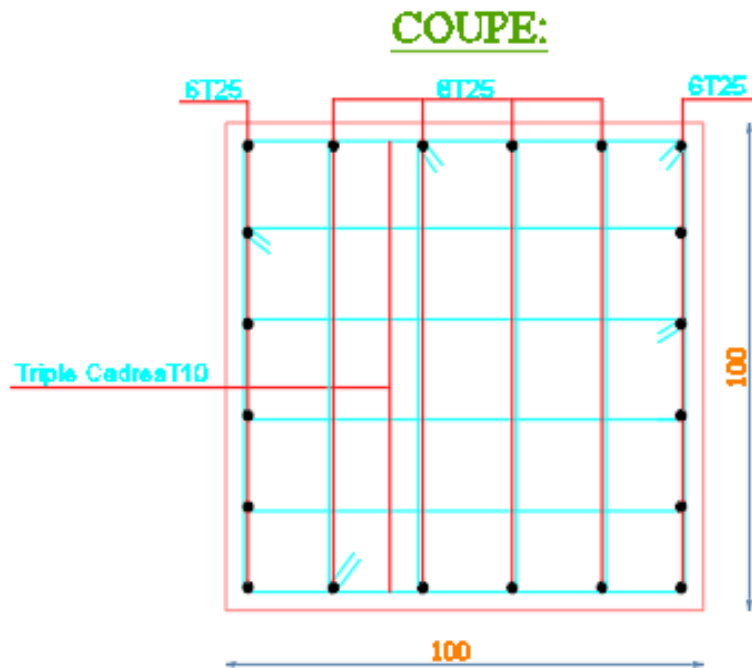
Schéma du ferrailage du poteau (100x100) cm²
